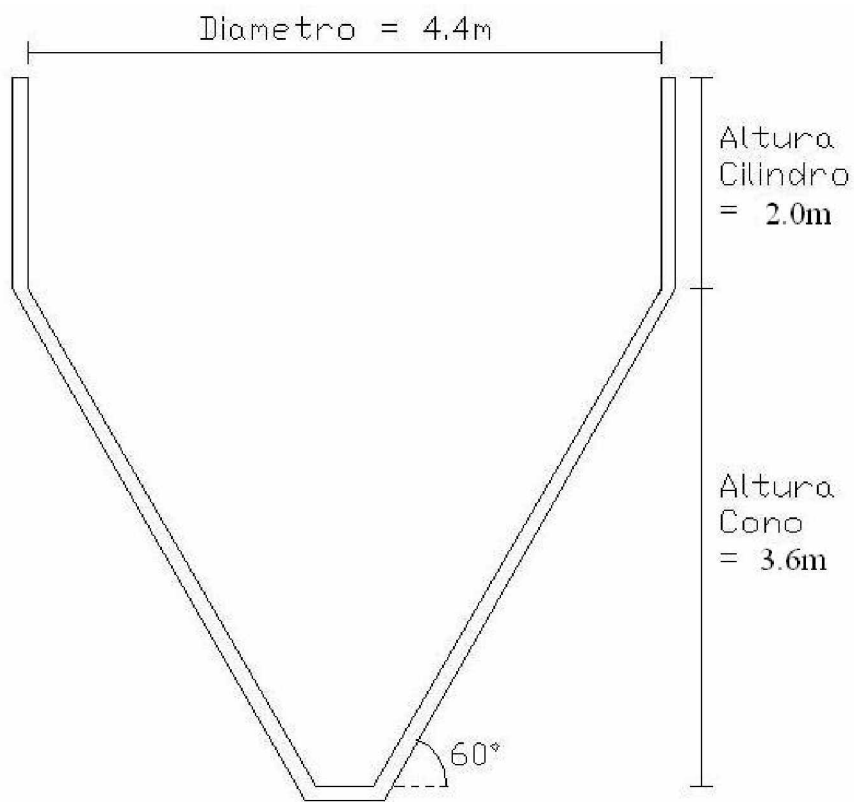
Sección del sedimentador primario de la Planta N°1
